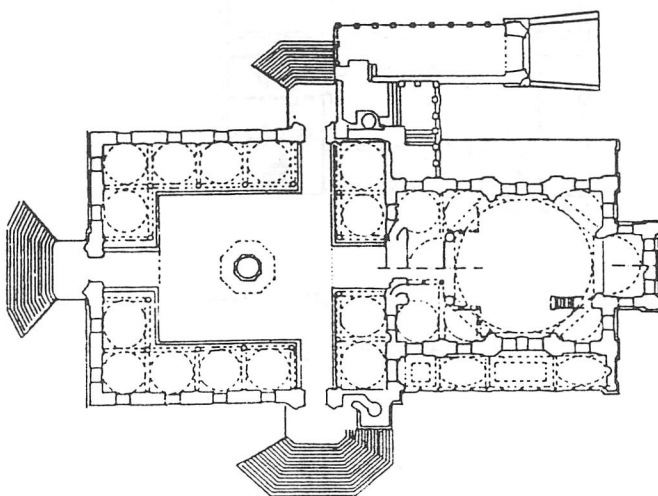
المسقط الأفقي لجامع نور عثمانية .
